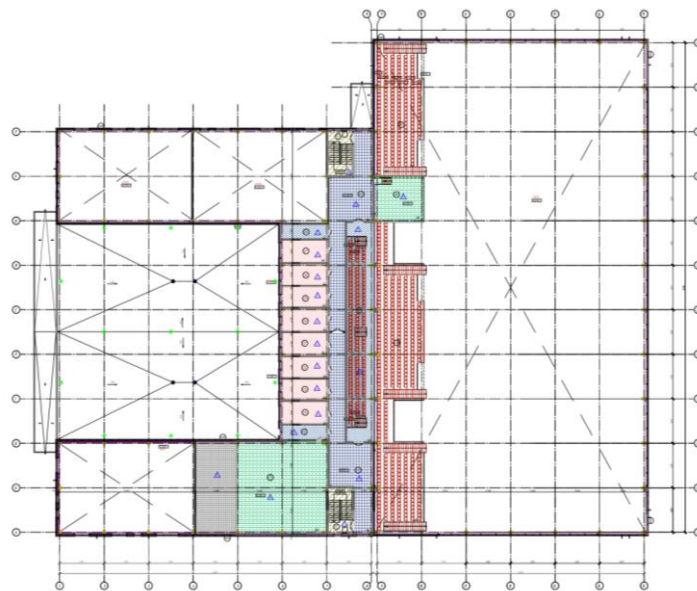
План этажа на отметке плюс 4,950 м
